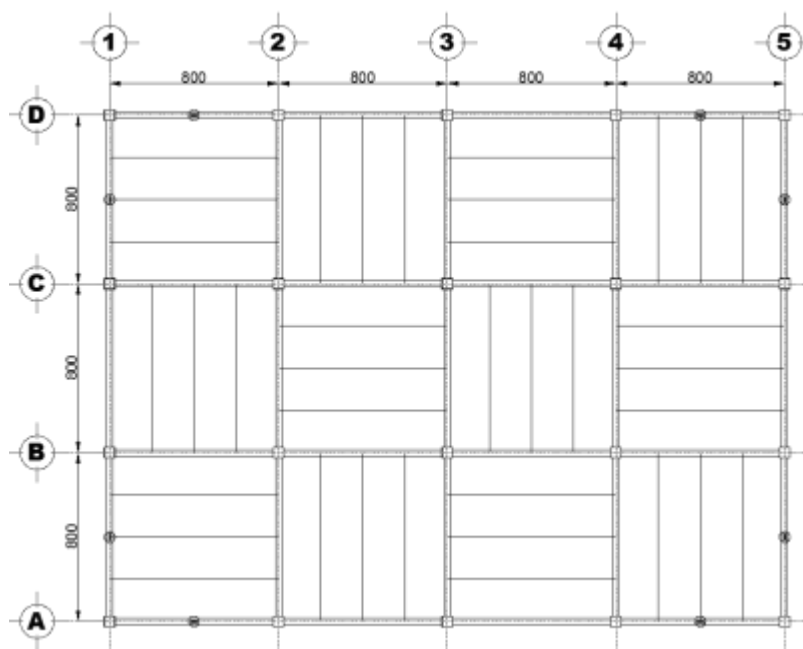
Planta estructural tipo de edificio (dimensiones en centímetros)
